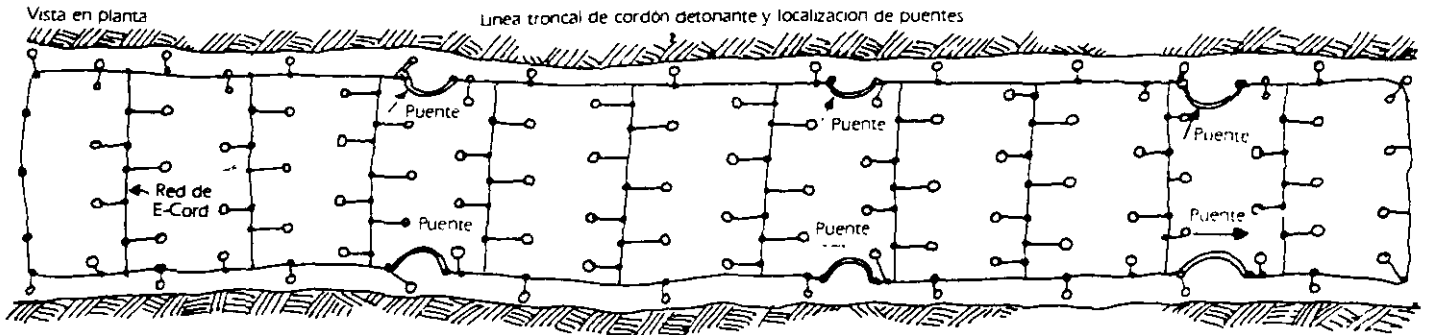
A. Conexión con "Gancho J" utilizado en un rebaje largo y angosto
